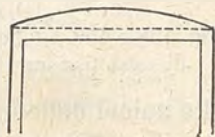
Traversa superiore di un telaio fisso da finestra.
